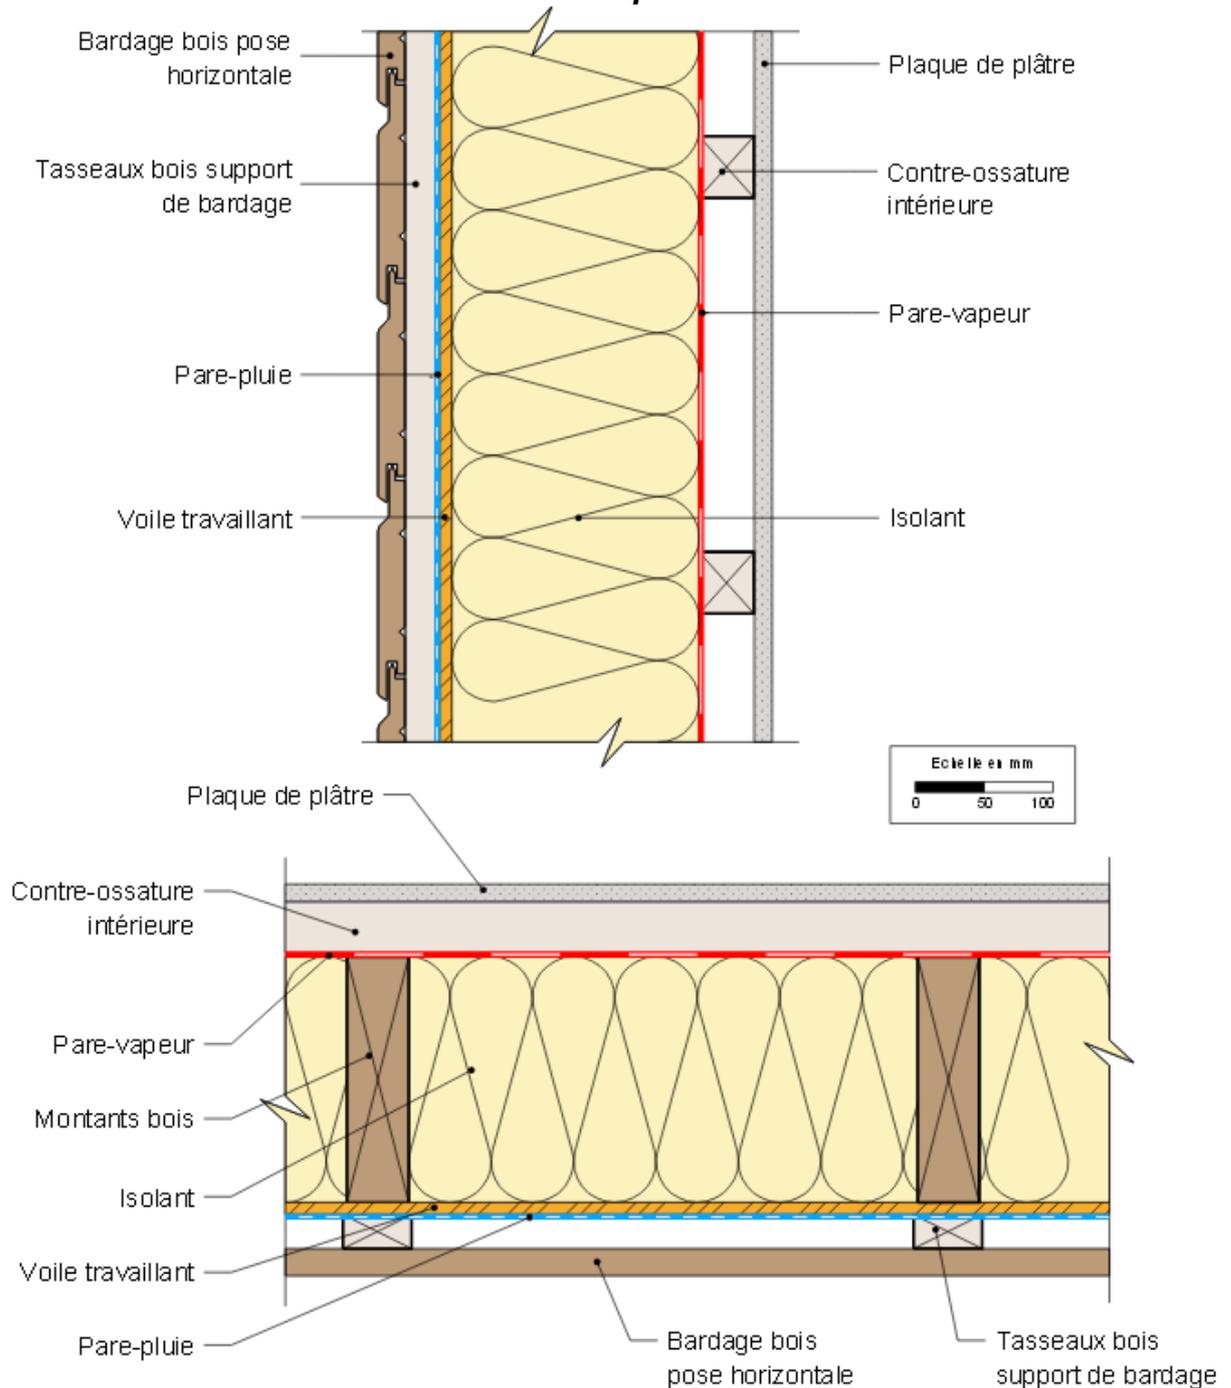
Contreventement extérieur (coupe verticale en haut, verticale en bas)
